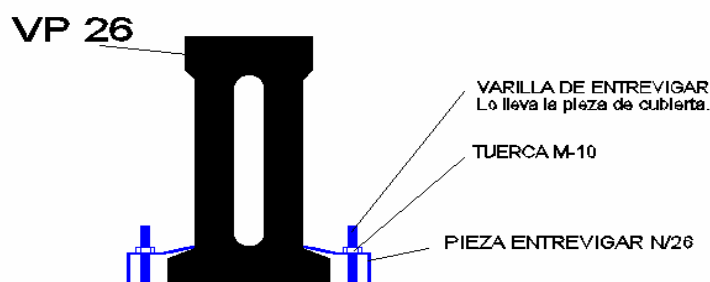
Detalle juego entrevigar para viga canto 26cm
